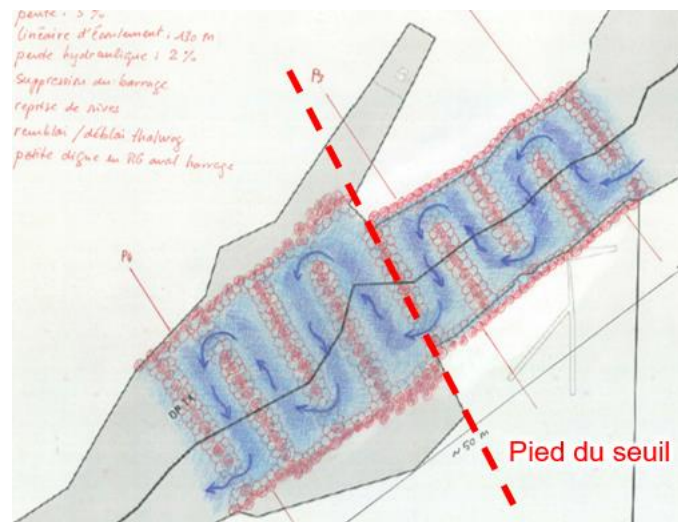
Variante 1 : rampe rugueuse centrée sur le seuil - croquis en plan
